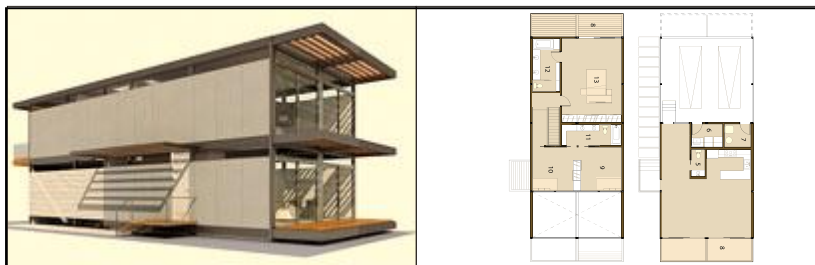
Living Home – RK4 – volume e planta baixa do térreo e segundo pavimento (<http://www.livinghomes.net>)
